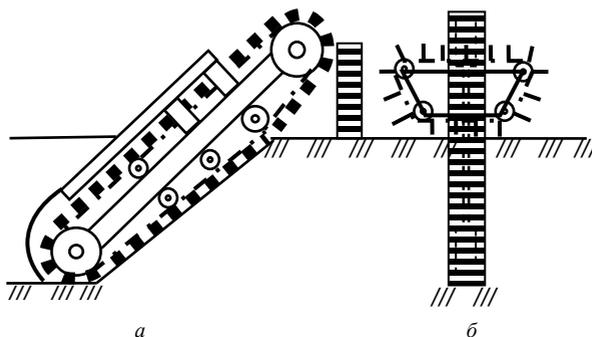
Схема скрепкового цепного траншекопателя с поперечным скрепковым цепным устройством для отодвигания вынутаго грунта:
